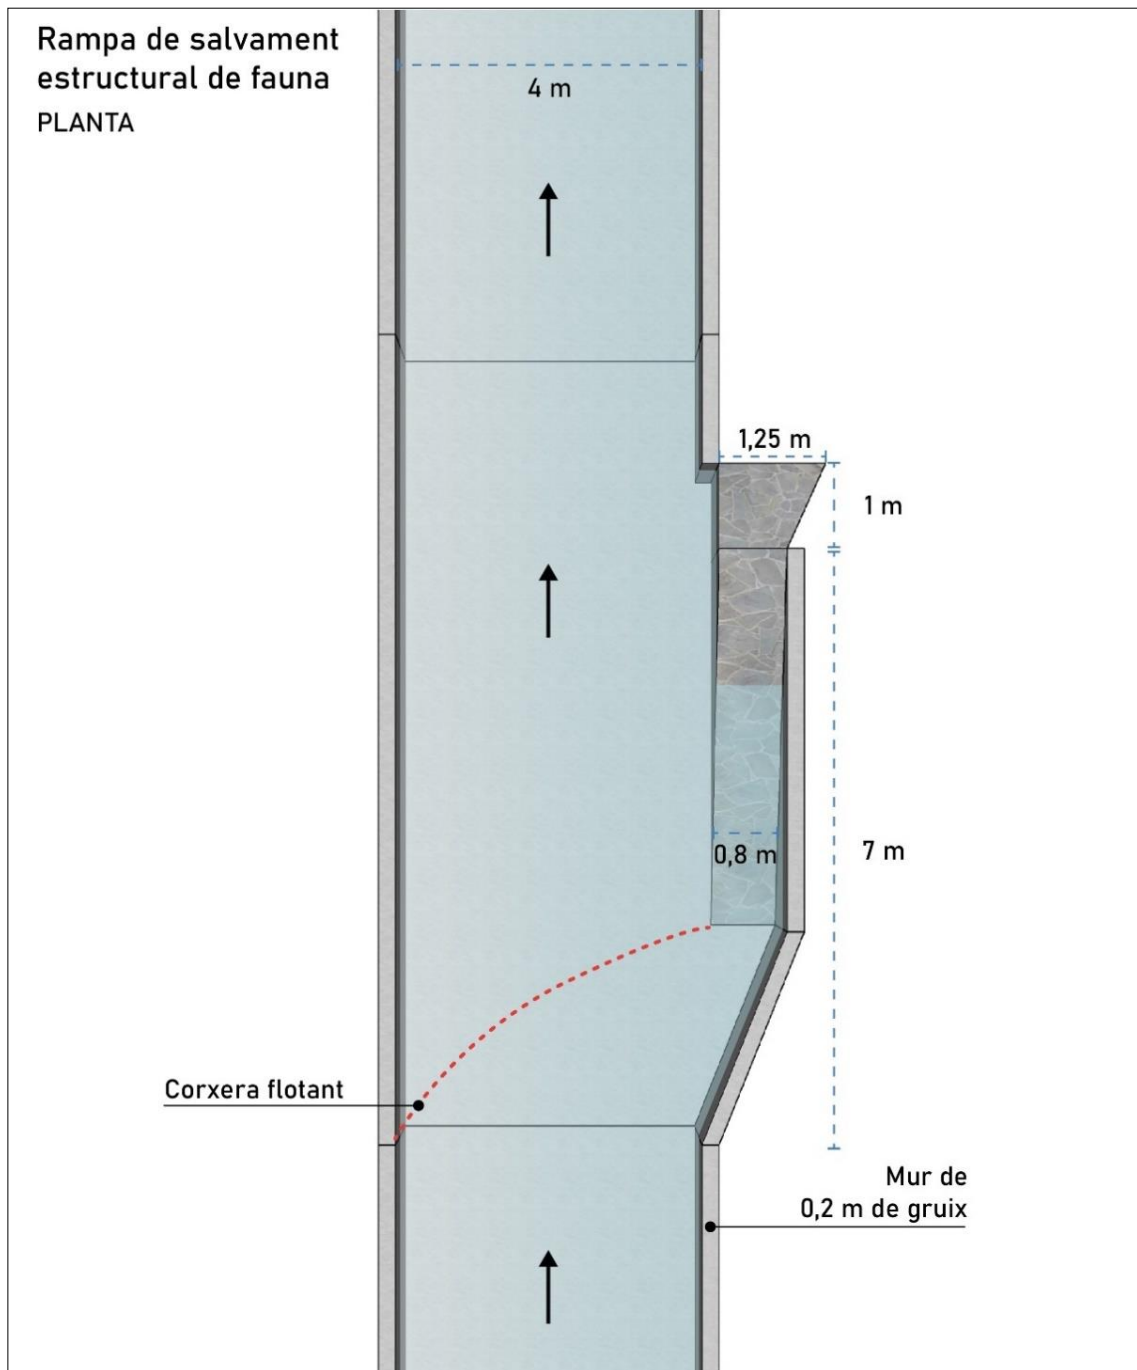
Esquema en alçat de la rampa estructural de salvament de fauna.
